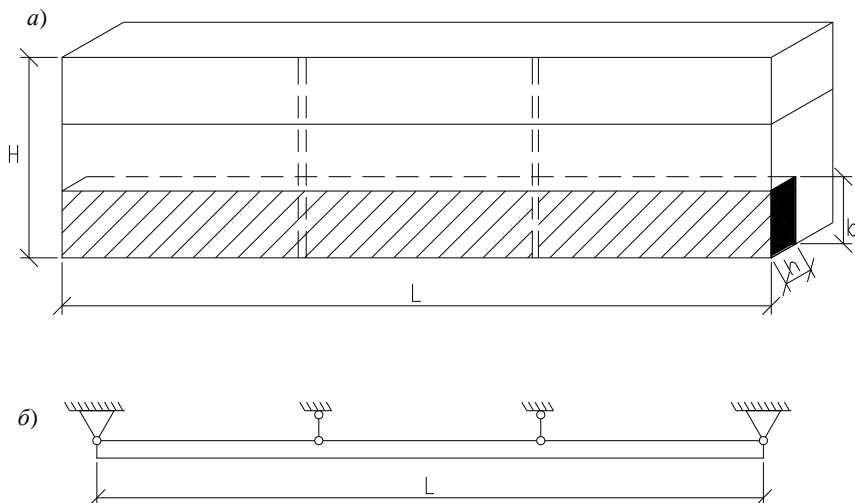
(начало) – Схемы к расчету опалубки:
